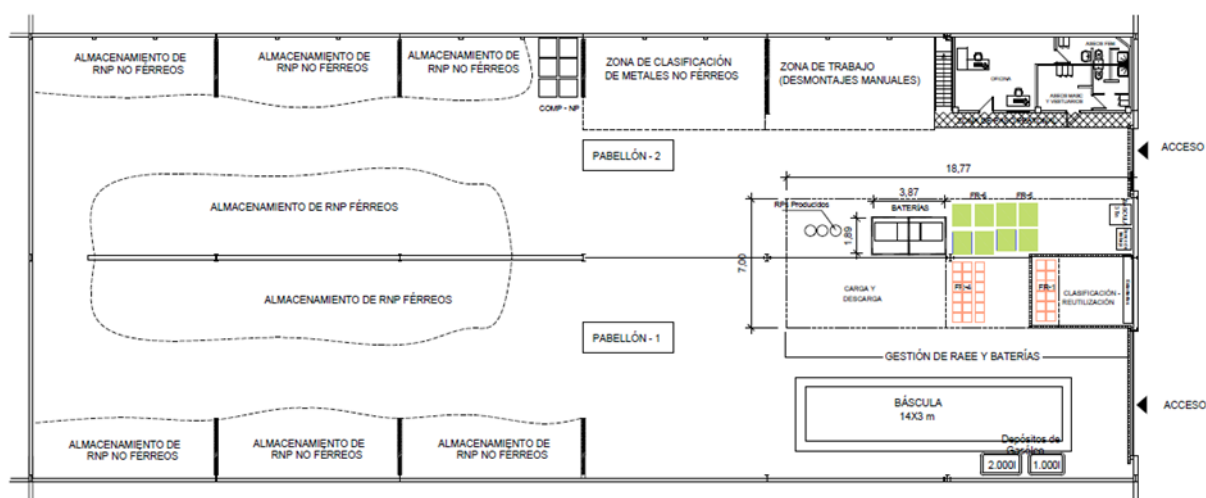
Planta de distribución Hierros Kortederra, S.L.U.
